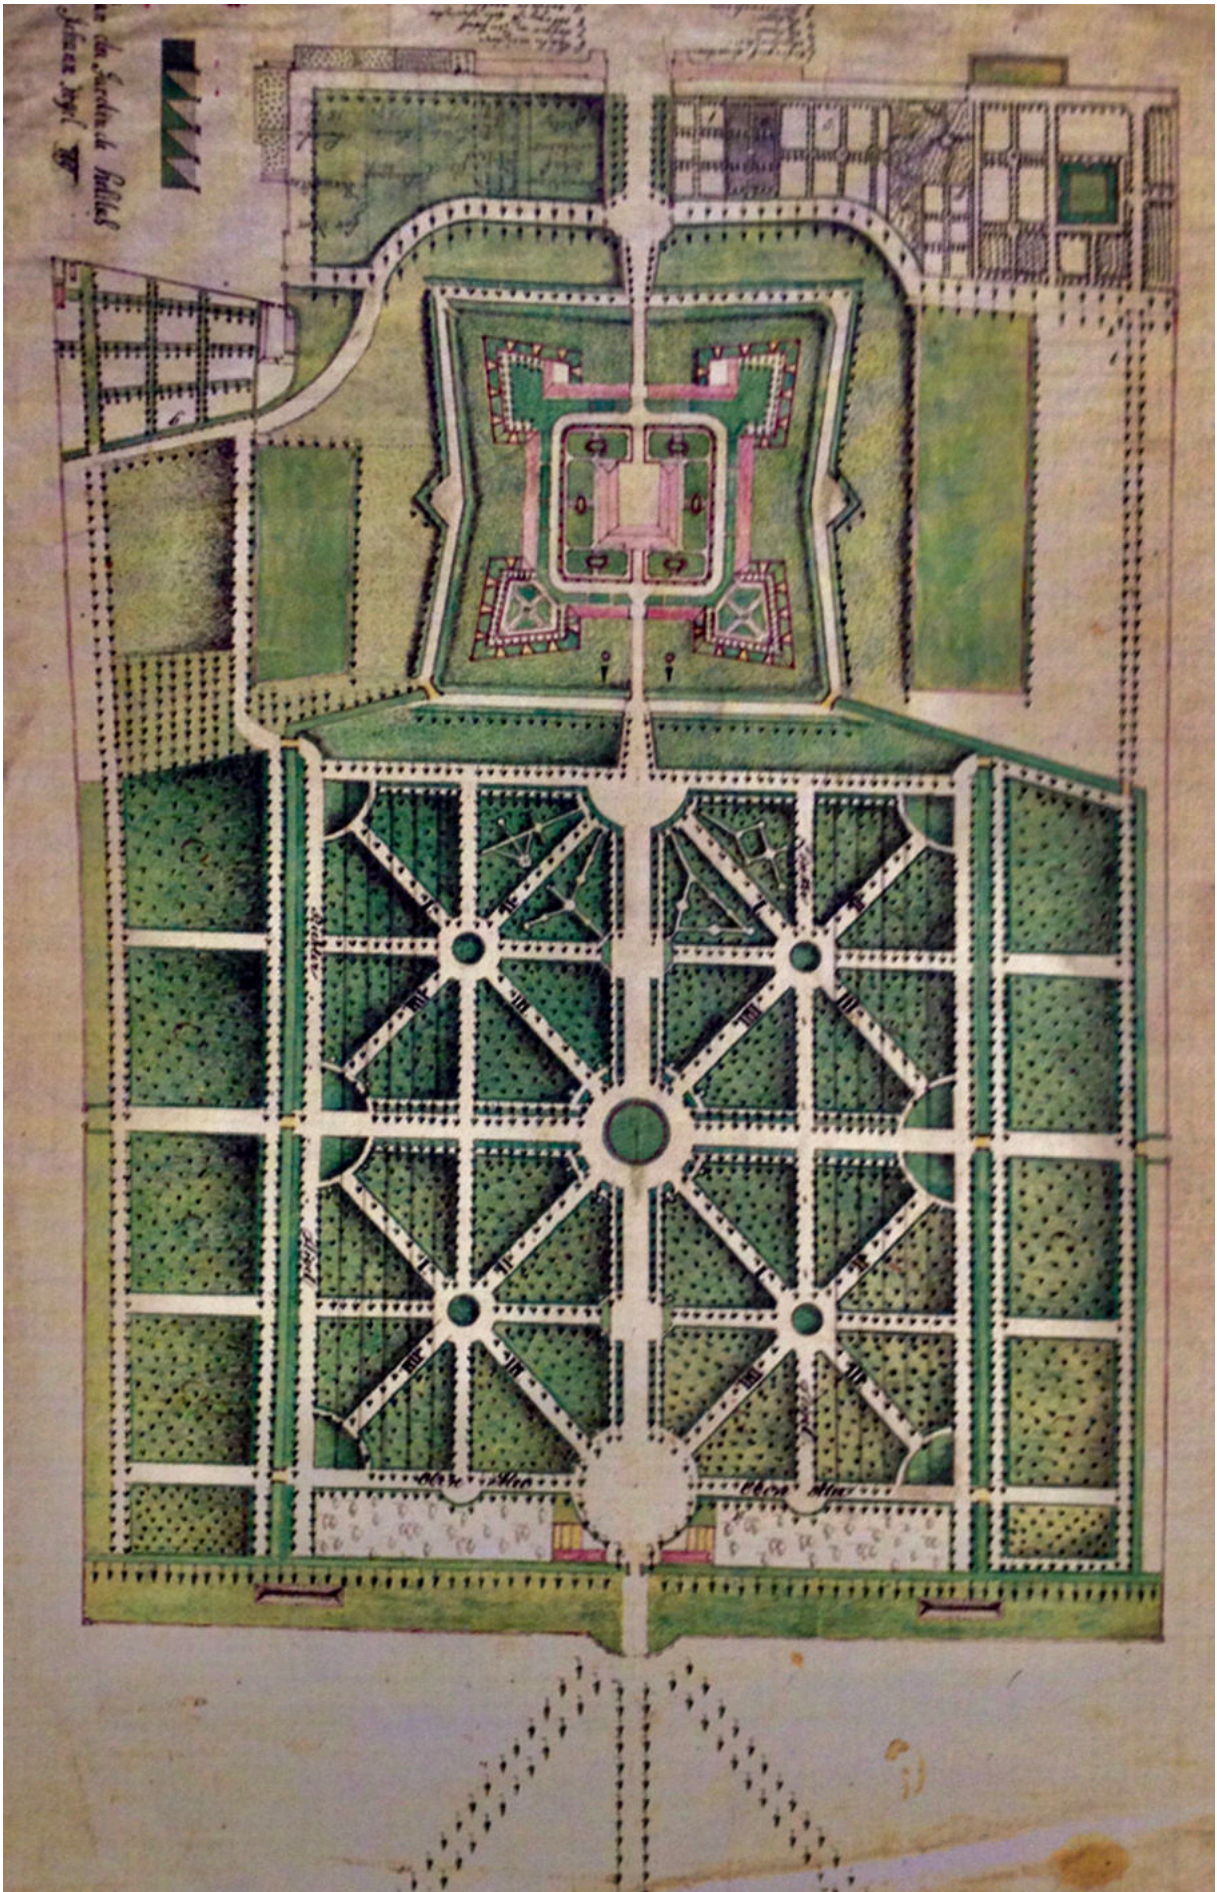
Grundriss der Schlossanlage von Holitsch, Federzeichnung, um 1799
